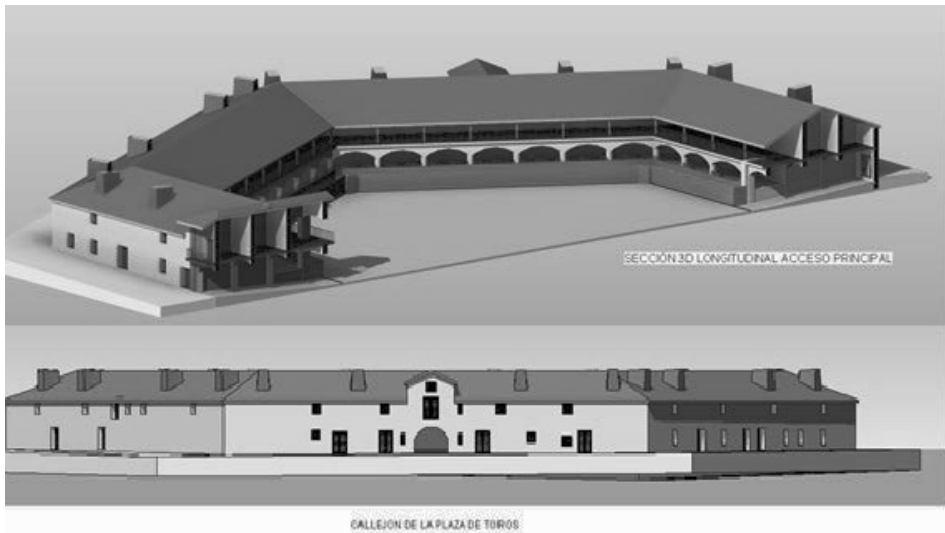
Sección por palco presidencial y alzado a Callejón de la Plaza de Toros.
